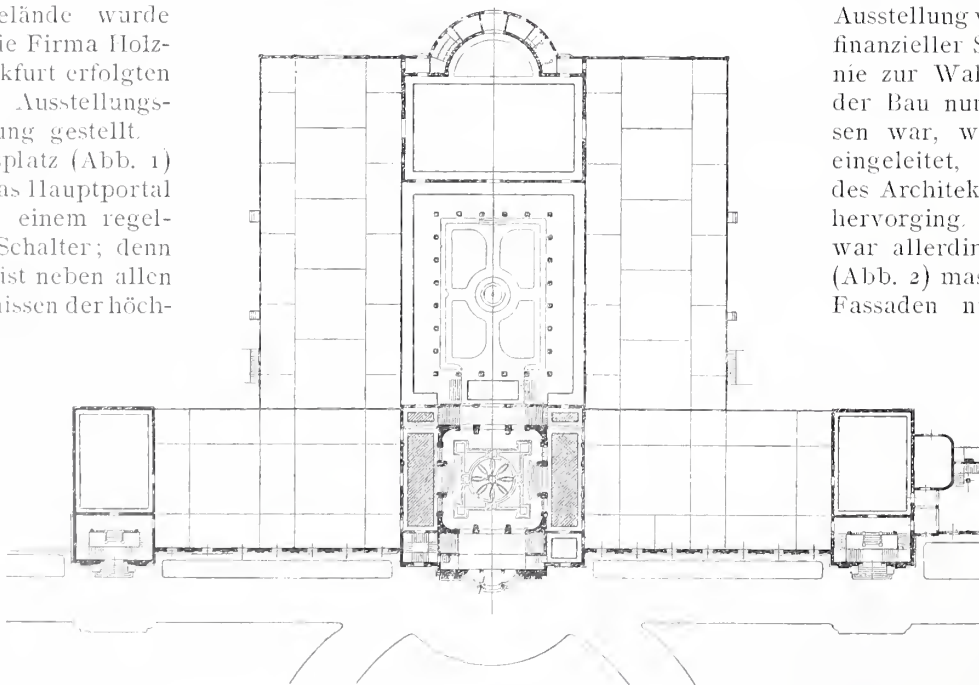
Die Kunsthalle. — Grundriss. — Masstab 1 : 1200.
